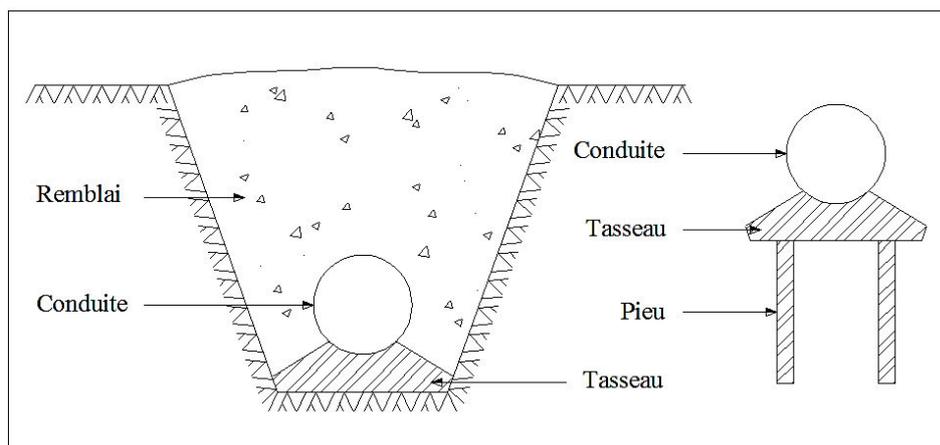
Pose de conduites dans un terrain peu consistant.
